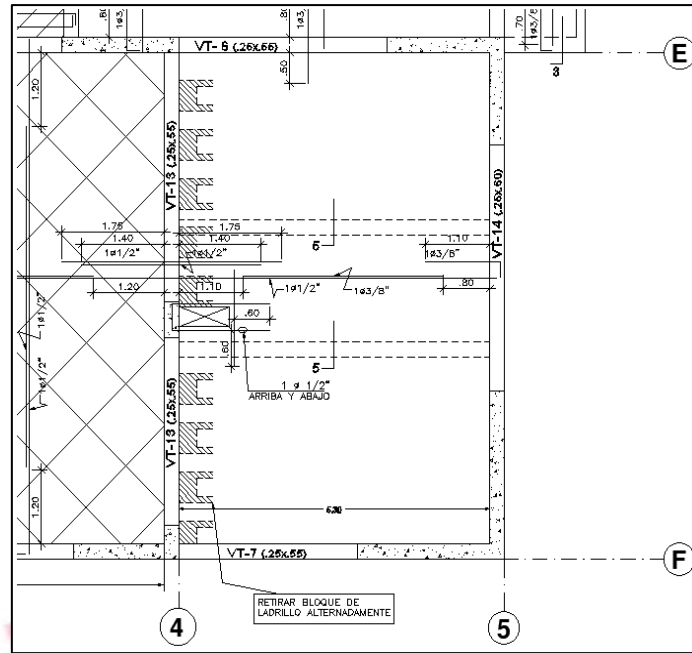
Distribución de refuerzo en losa aligerada con peralte de 0.25 m.
